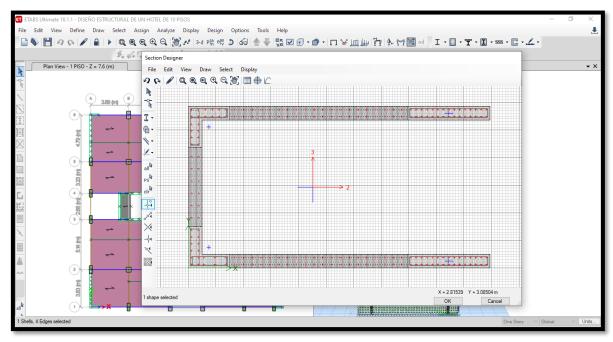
Vista en planta del armado de acero en la sección de la escalera: PL – 03.
